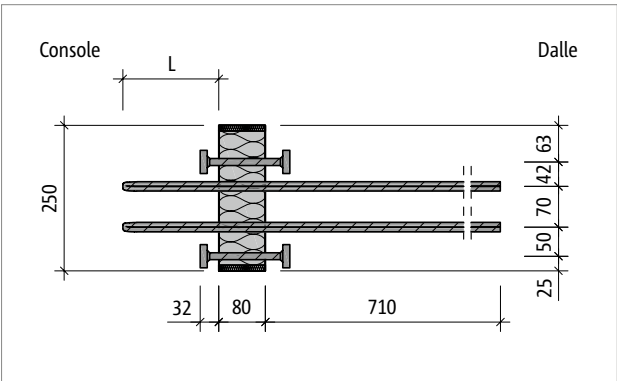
Schöck Isokorb® T type O : plan de base du produit
